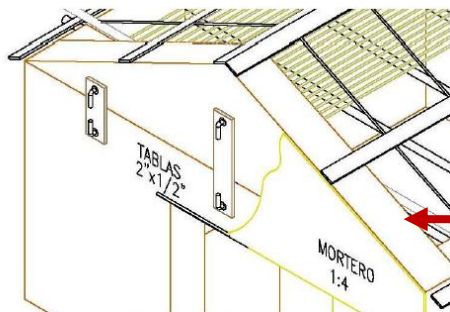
Propuesta de reforzamiento de vivienda rural viga collar/malla galvanizada.
